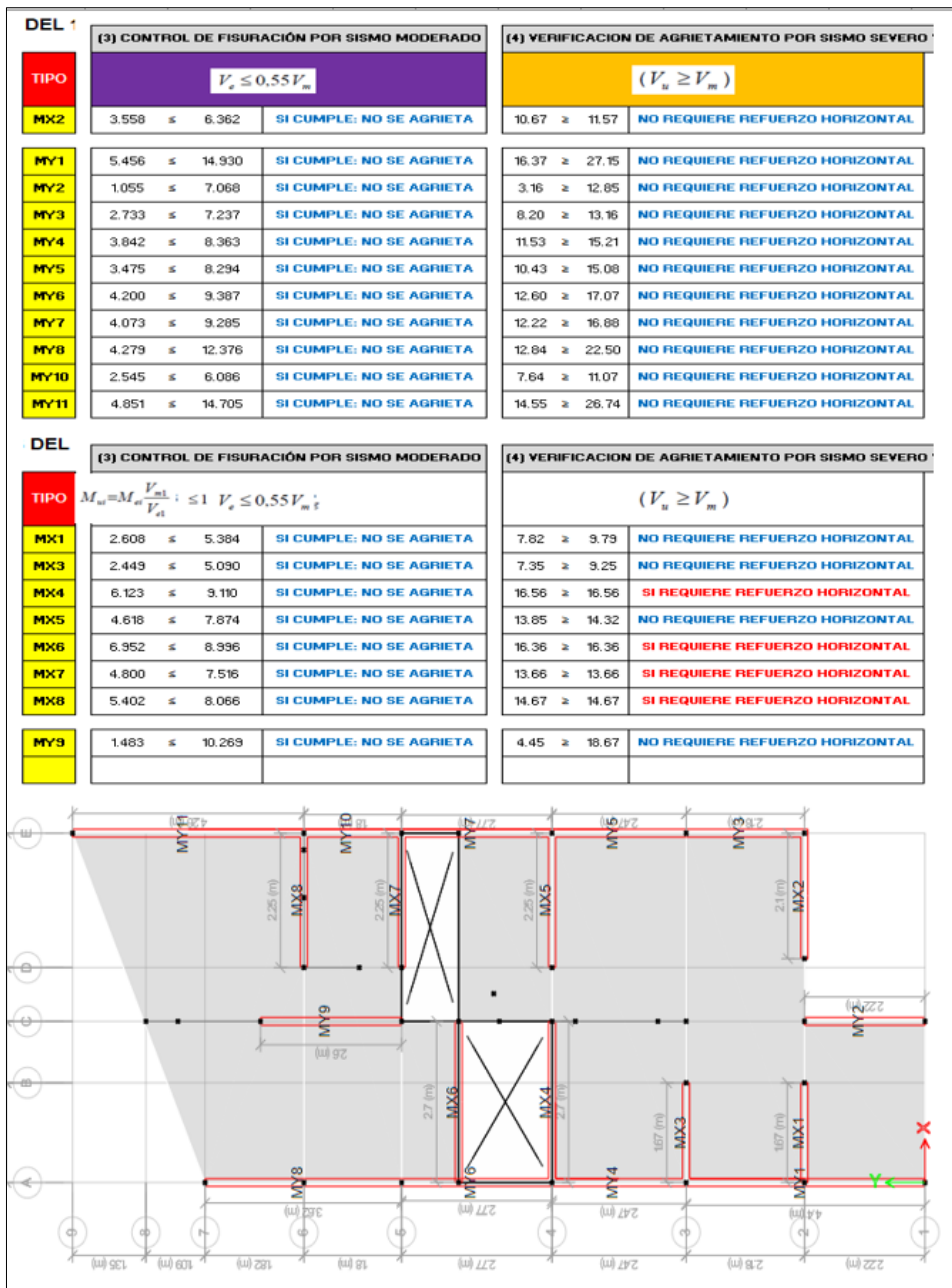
Control de fisuración por sismo severo y moderado de la vivienda 04
